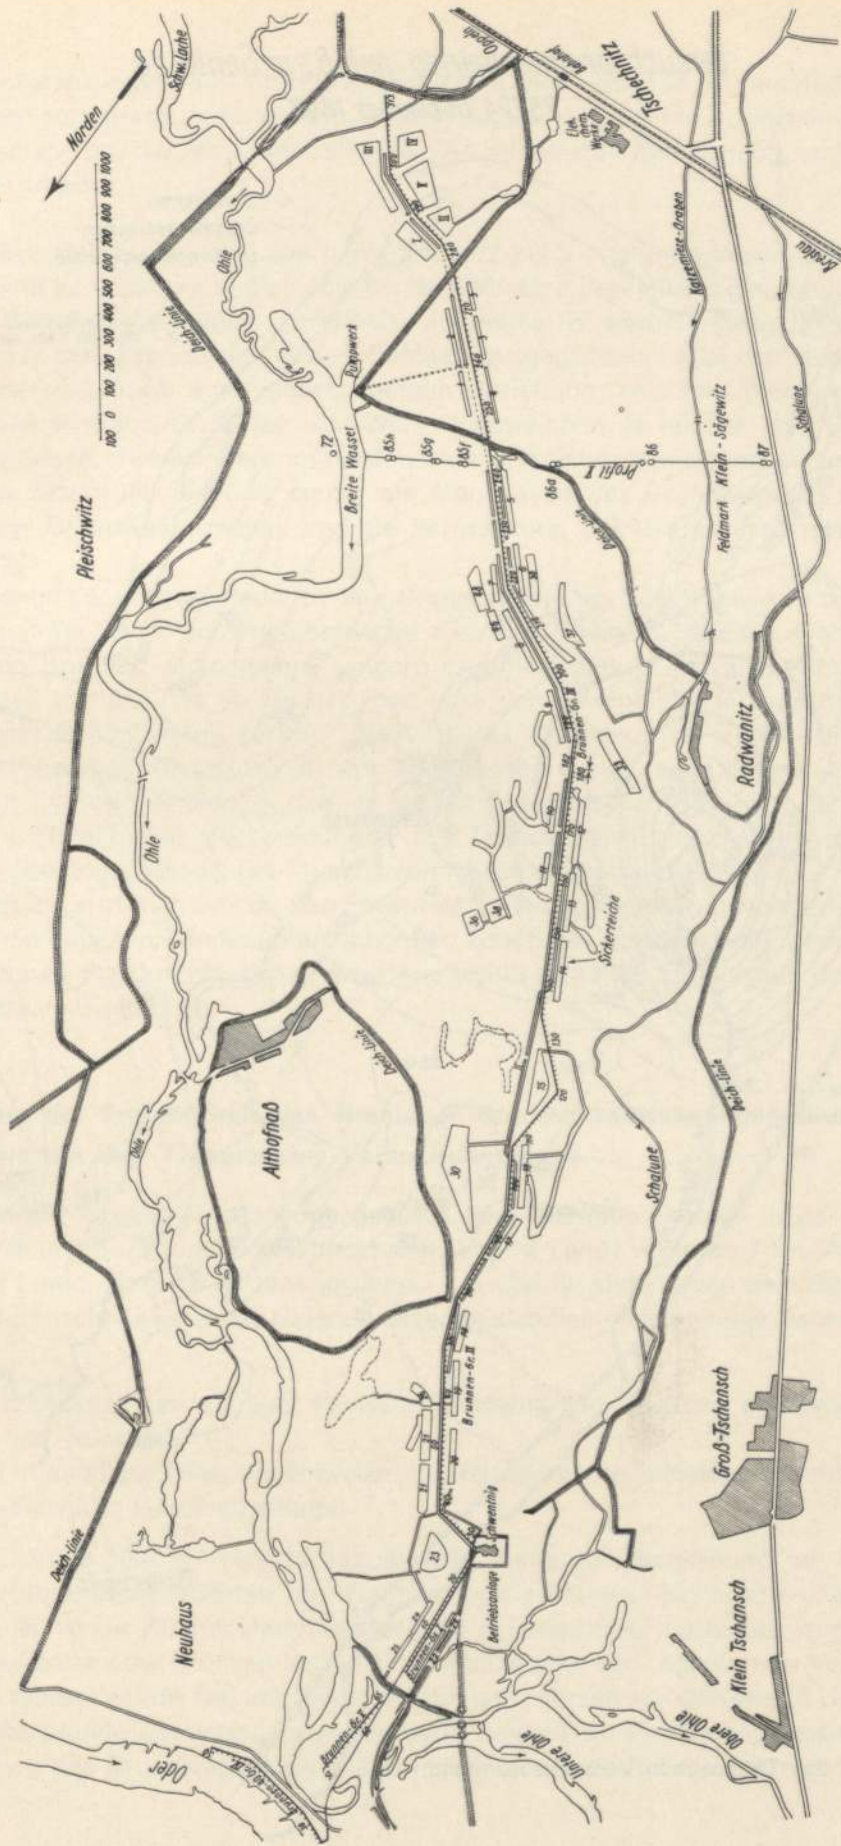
Lageplan des Breslauer Grundwasserfassungsgeländes
